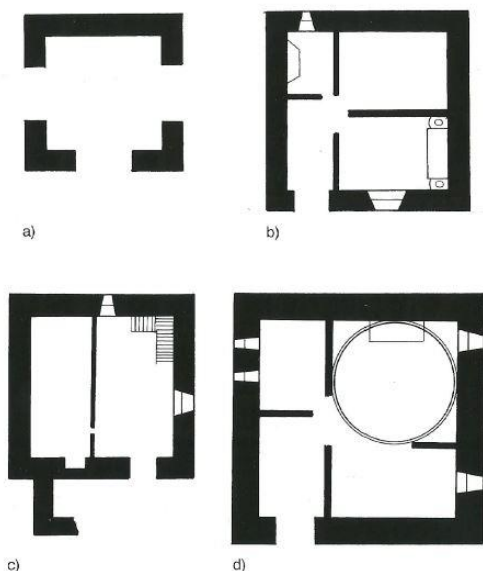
Plantas de varias Ermitas-vivienda (desaparecidas)
